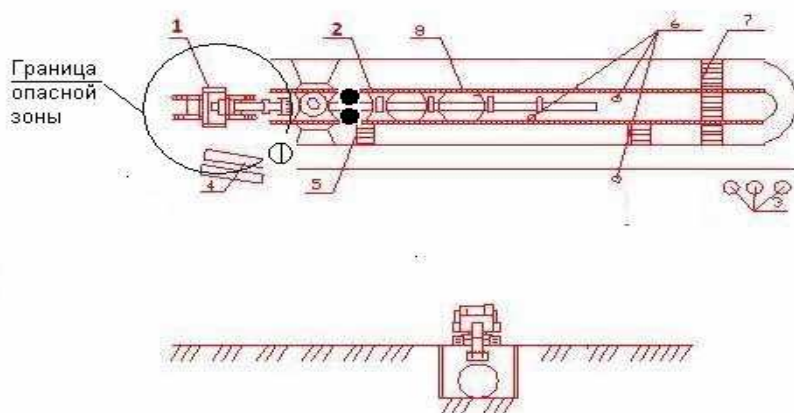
Схема производства работ по укладке стеклопластиковых труб
